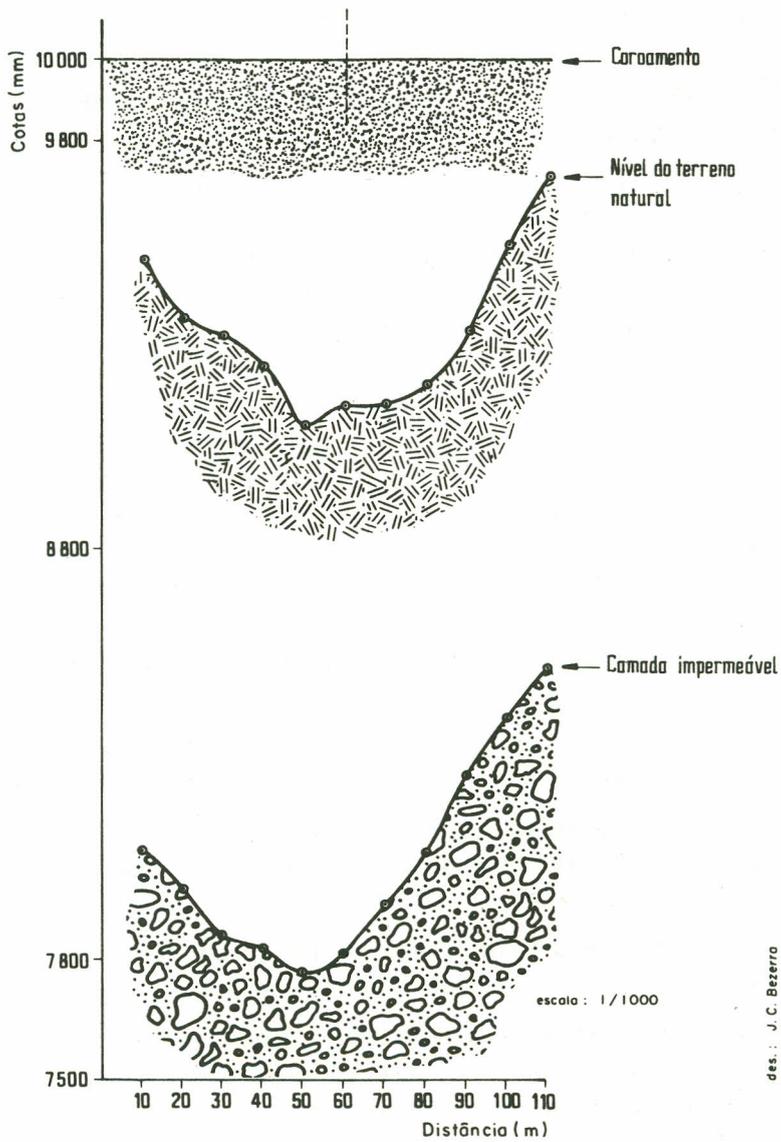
Perfil do terreno e da camada impermeável na barragem subterrânea III.
